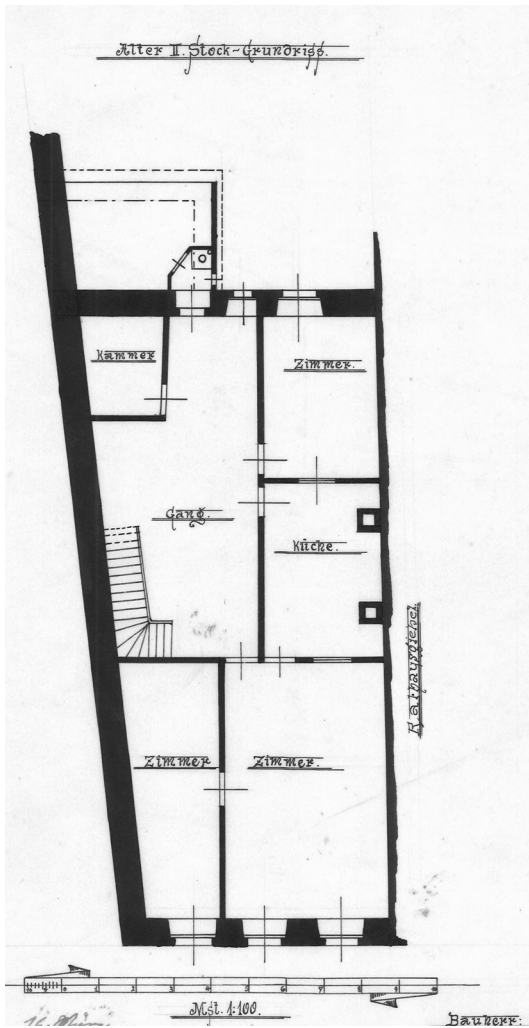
(links): Hauptstraße 51, Grundriss 1. Obergeschoss, Plan von 1900.
